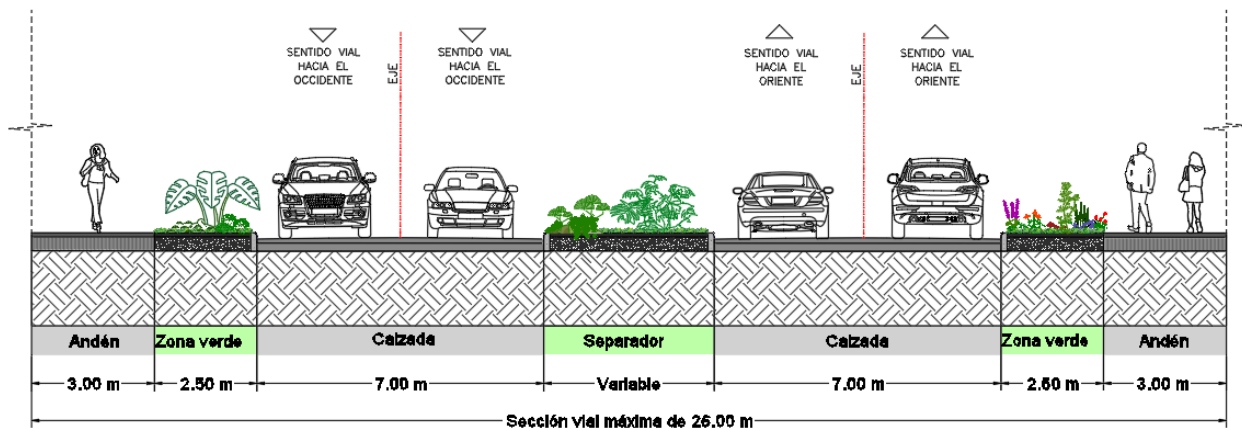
Sección vial dos (2) propuesta Villas de Gualanday y la intersección con la Transversal 24A.
